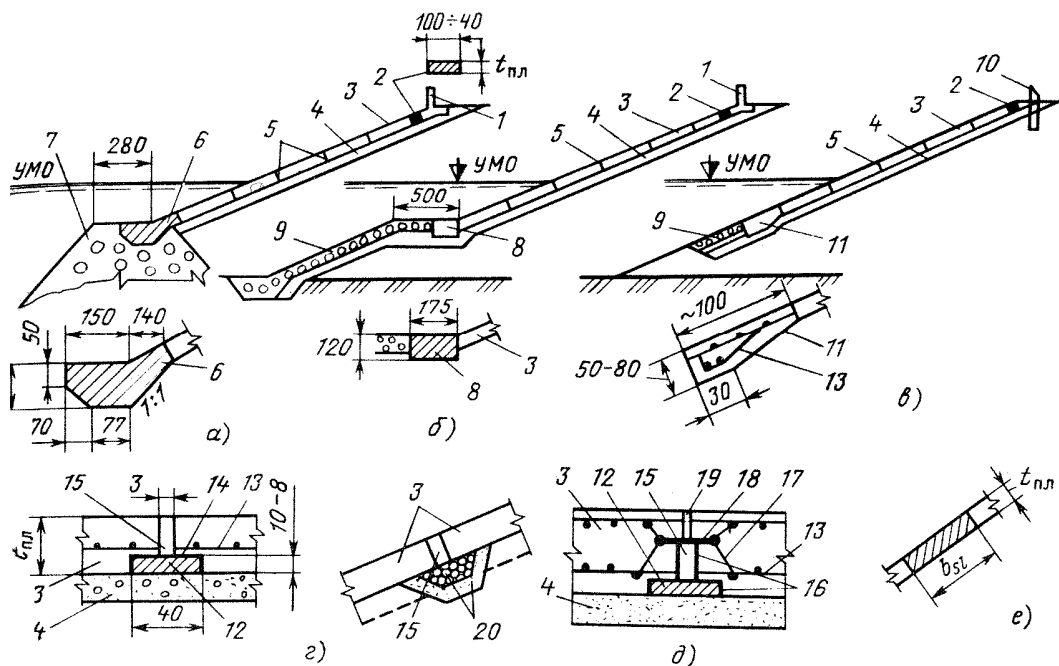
Крепление верхового откоса земляных плотин монолитными железобетонными плитами:
